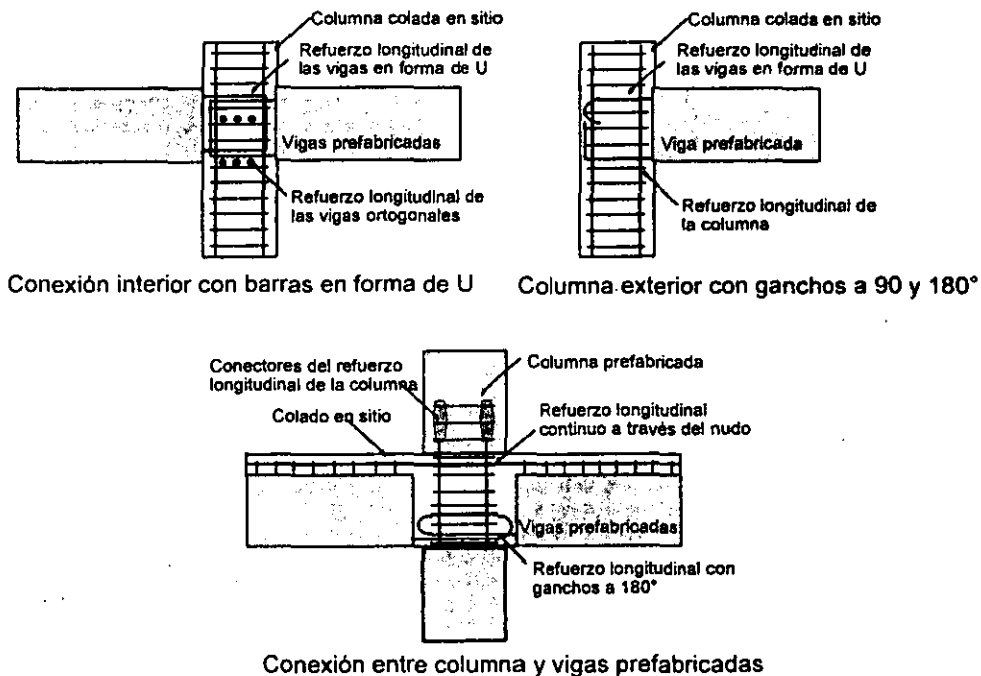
Conexiones viga-columna más comunes utilizadas en Japón
